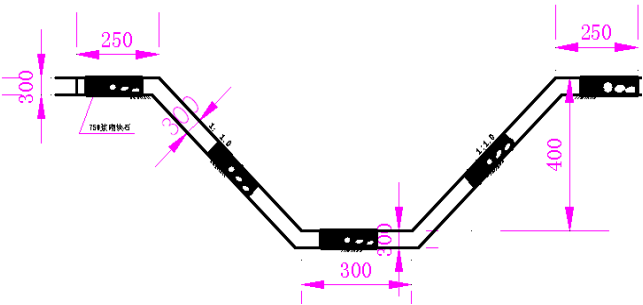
排水沟设计剖面图 (图中尺寸为 mm)
